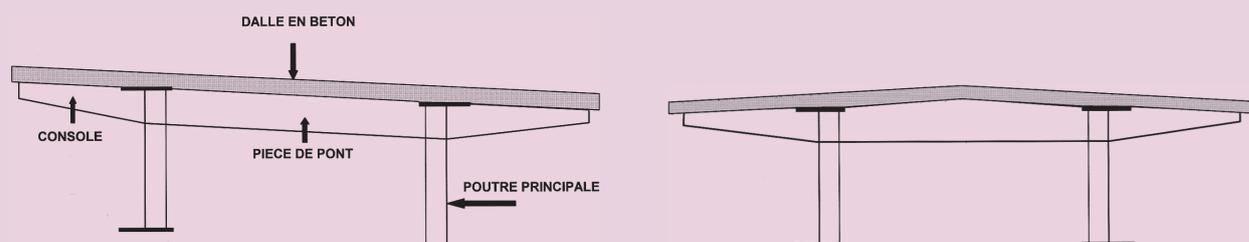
Bipoutre à pièces de pont avec consoles (à gauche, cas d'une chaussée monodévers ; à droite, cas d'une chaussée à dévers en toit)
